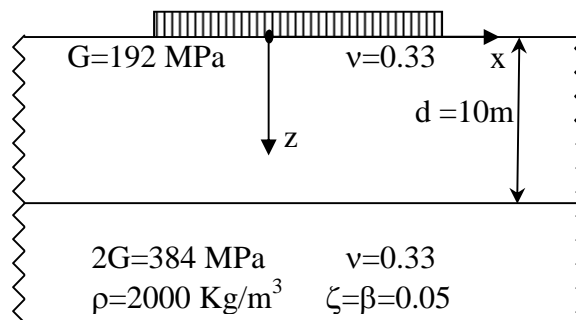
fondation de forme arbitraire reposante sur la surface d'un sol monocouche surmontant un demi-espace rigide
